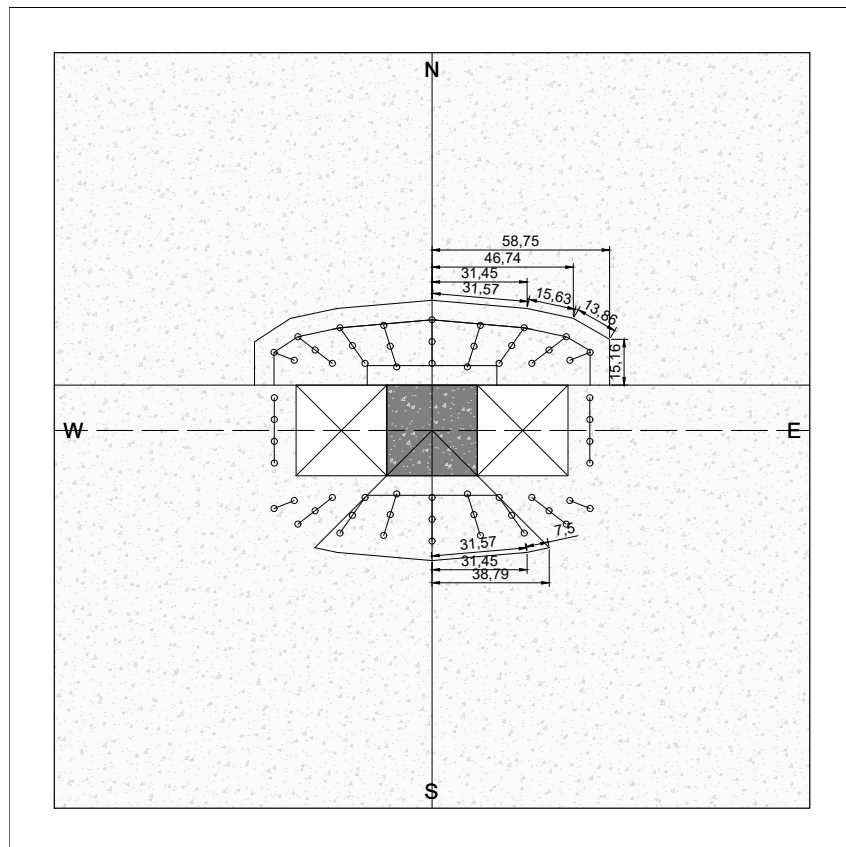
Perímetros externos segundo ACI 318-19 da laje LFS3
